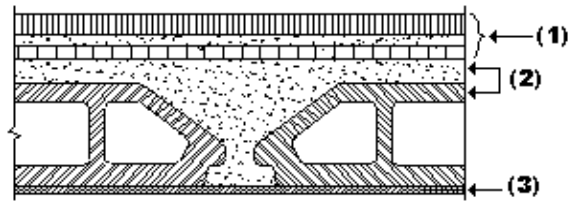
coupe de plancher à corps creux (étage courant)
